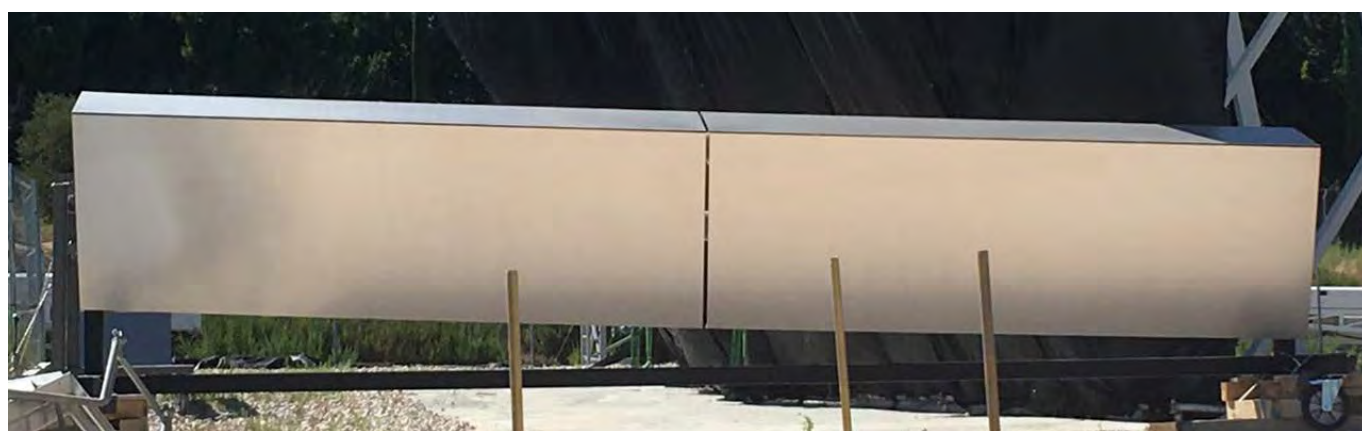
Fotografías de las muestras fabricadas para verificar la planimetría alcanzable por el sistema constructivo y método de fabricación digital previsto.
